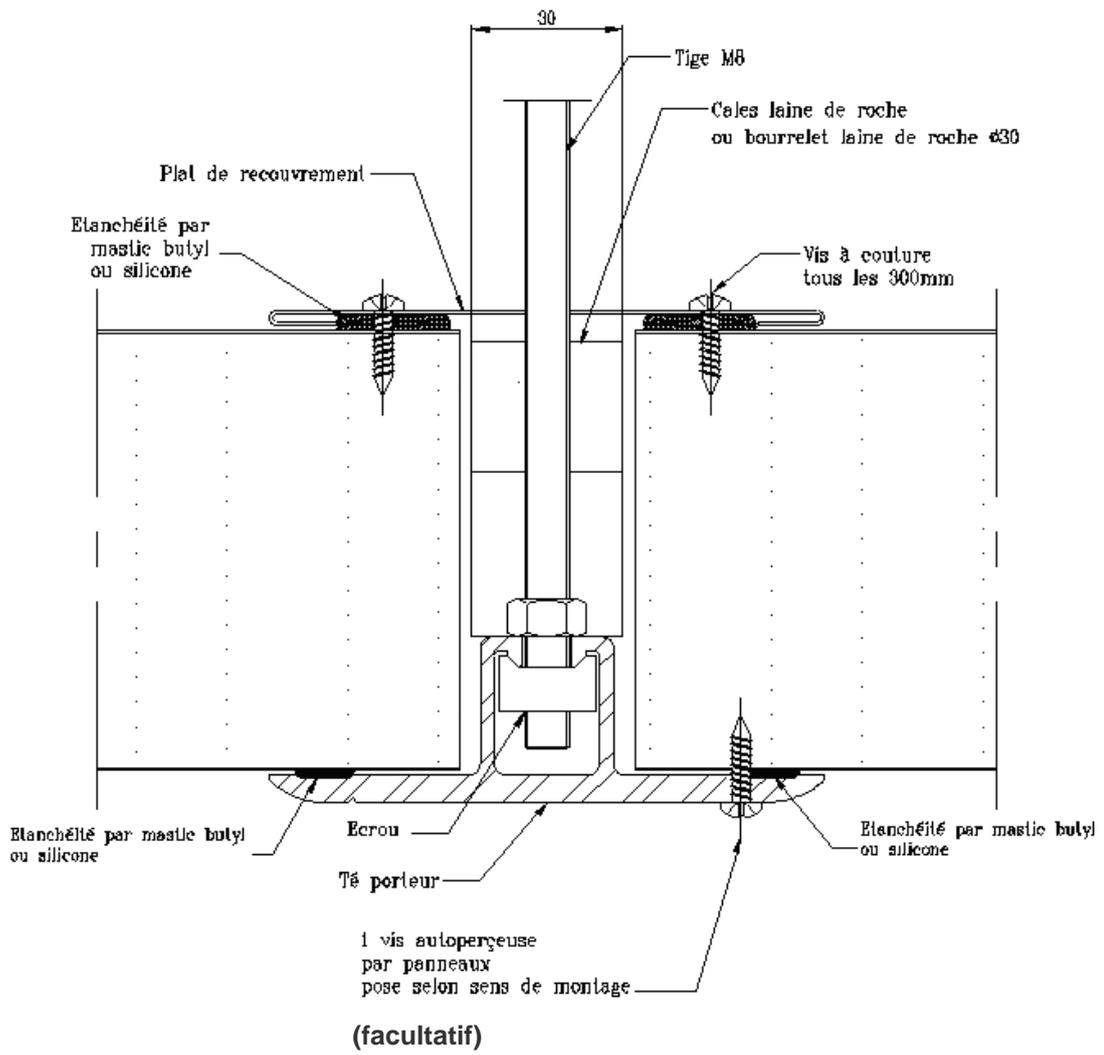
Pose sur Té aluminium des panneaux LF en plafond
